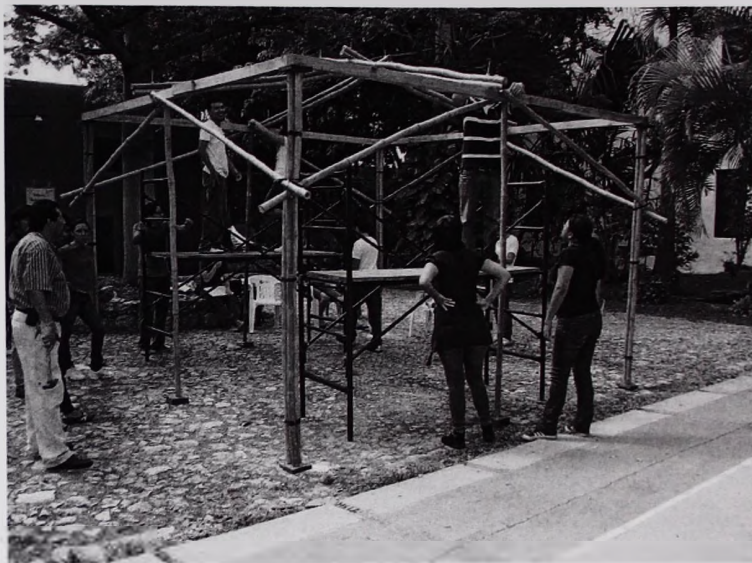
Estructura de la techumbre y estructura auxiliar terminadas
